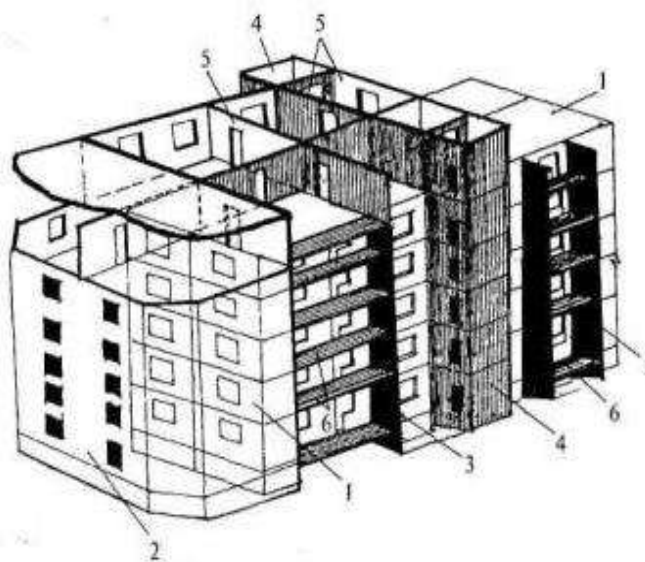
Конструктивна схема надбудови поверхів на виносні рамні конструкції: 1 - будівля, що реконструюється; 2 - торцева прибудова; 3 – монолітні залізобетонні пілони; 4 - монолітні прибудови ліфтових шахт; 5 - балки-стілки для передачі навантажень від надбудовуваних поверхів пілонам та об'ємним елементам шахт; 6 - монолітні плити лоджій, поєднані з пілонами.
